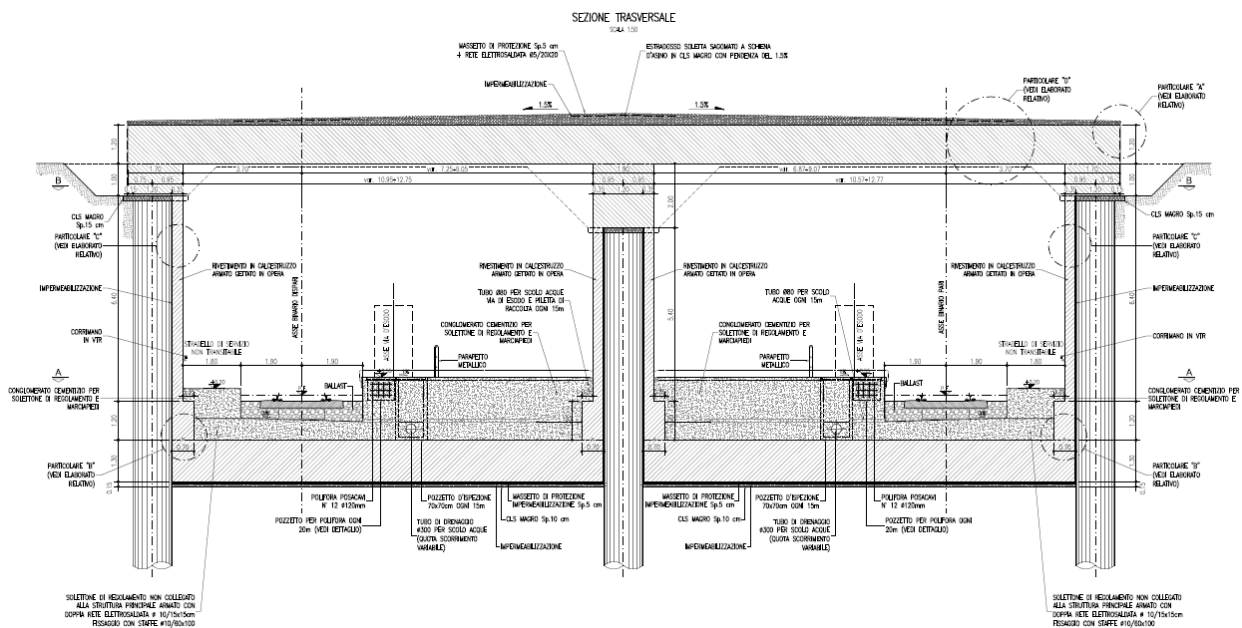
Sezione tipica M3 doppia canna con setto
